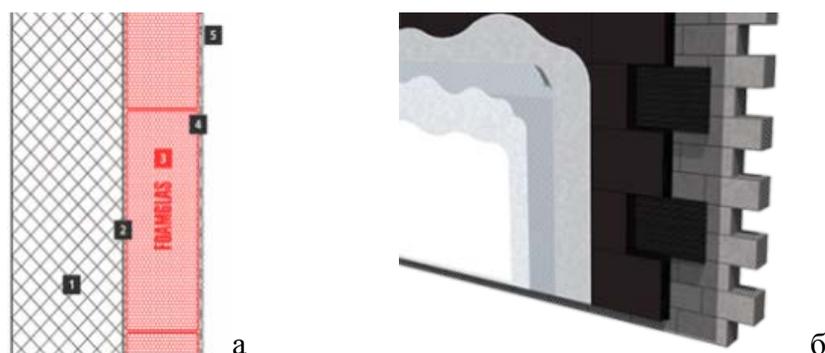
Схемы: а – фасадная тонкослойная штукатурка с утеплением плитным пеностеклом: 1. Стена; 2. Грунтовка; 3. Приклейка пеностекляных плит на мастику; 4. Армированный базовый штукатурный слой; 5. Финишный штукатурный слой; б – перспективный вид
